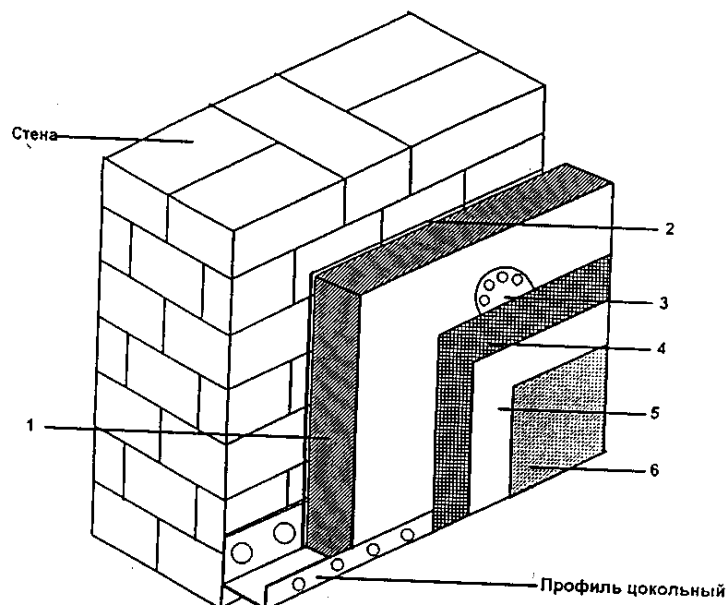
Фрагмент фасада ССТИ: 1 – плиты теплоизоляционные; 2 – полимерная клеящая масса для приклеивания плит к любой стене; 3 – дюбели для дополнительного крепления плит; 4 – предохраняющий слой из полимерной клеящей массы, армированный сеткой из стекловолокна; 5 – грунтовка; 6 – полимерное штукатурное покрытие произвольного цвета и фактуры.
